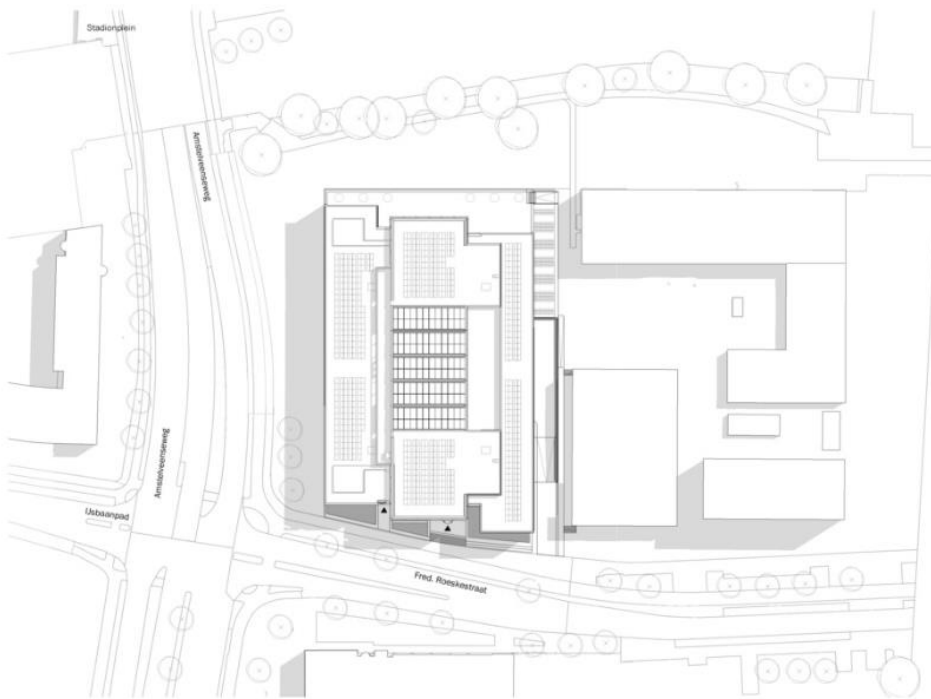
Office EDGE Stadium Генеральний план будівлі[16]
